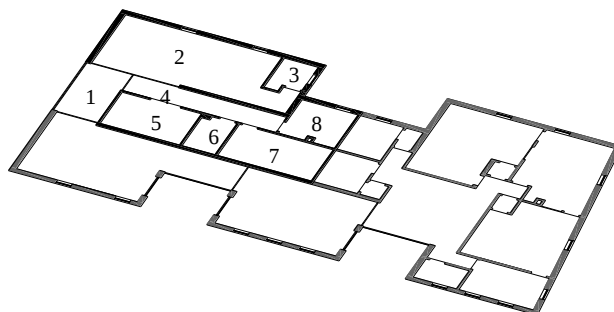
| Planta esquemática do Piso Térreo, Serviço de Urgência.
